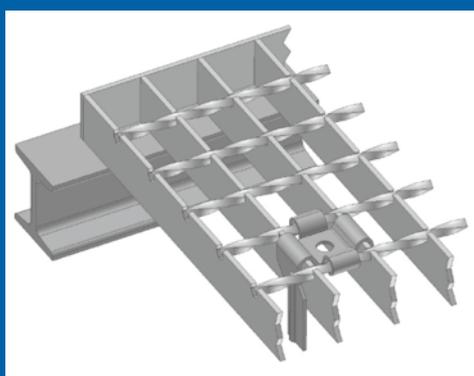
exemple de mesure technique (à réaliser ultérieurement) empêchant la pose erronée d'un caillebotis carré.
